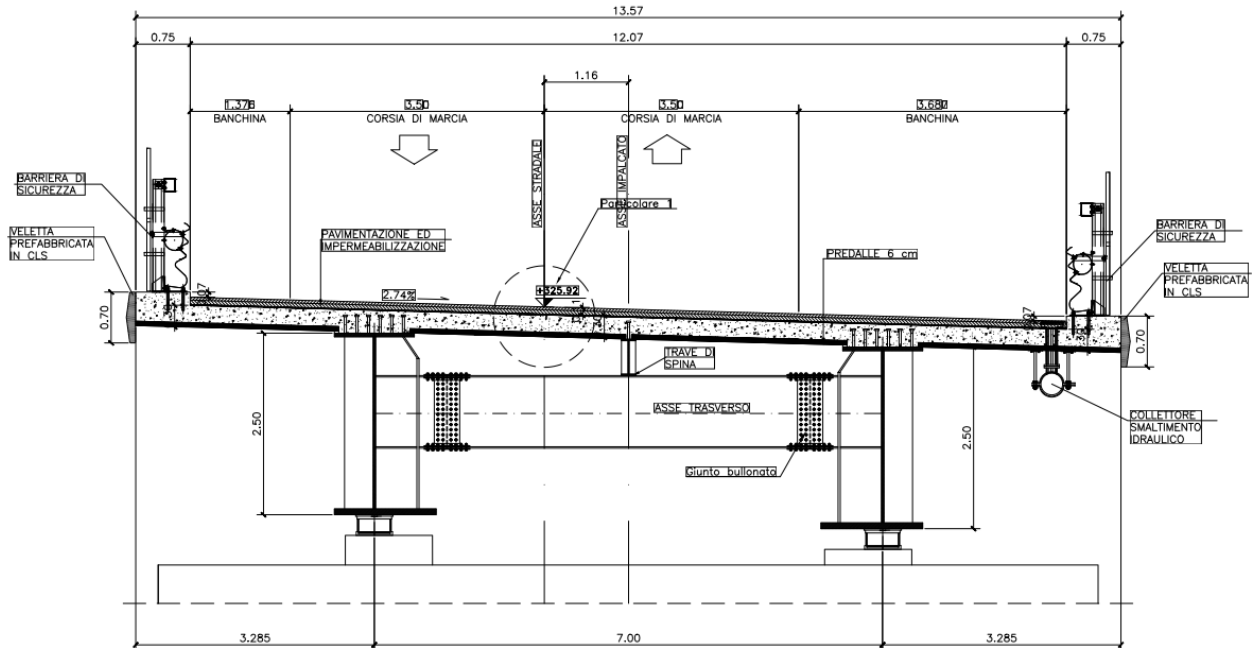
Sezione trasversale dell'impalcato - sezione allargata su spalla S2)
